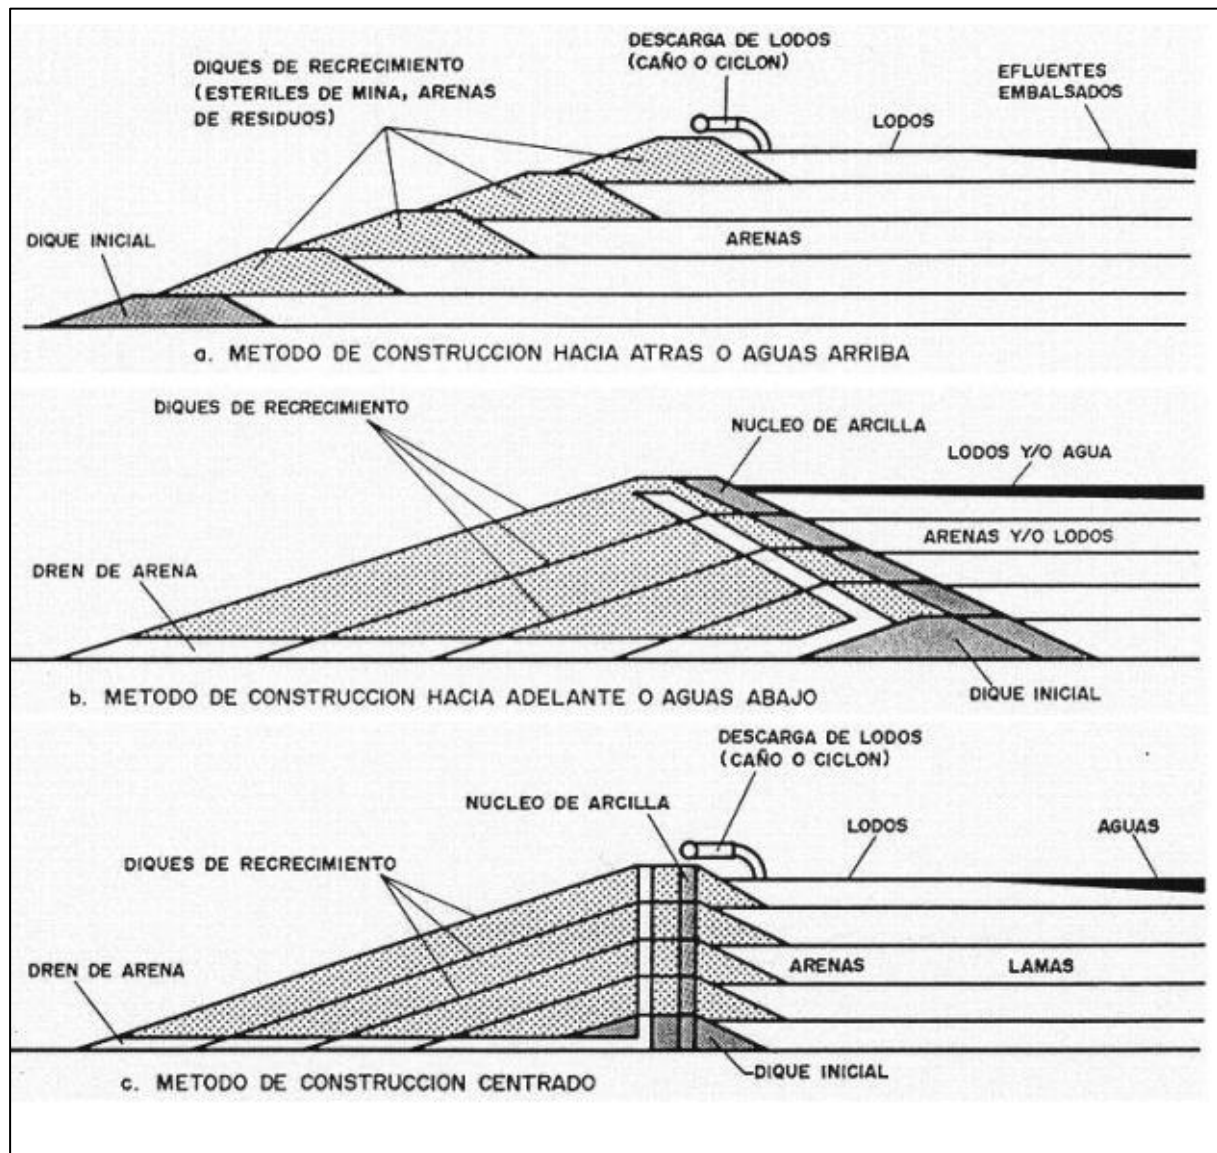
Tipos constructivos de presas mineras (Andrea, 2014)
